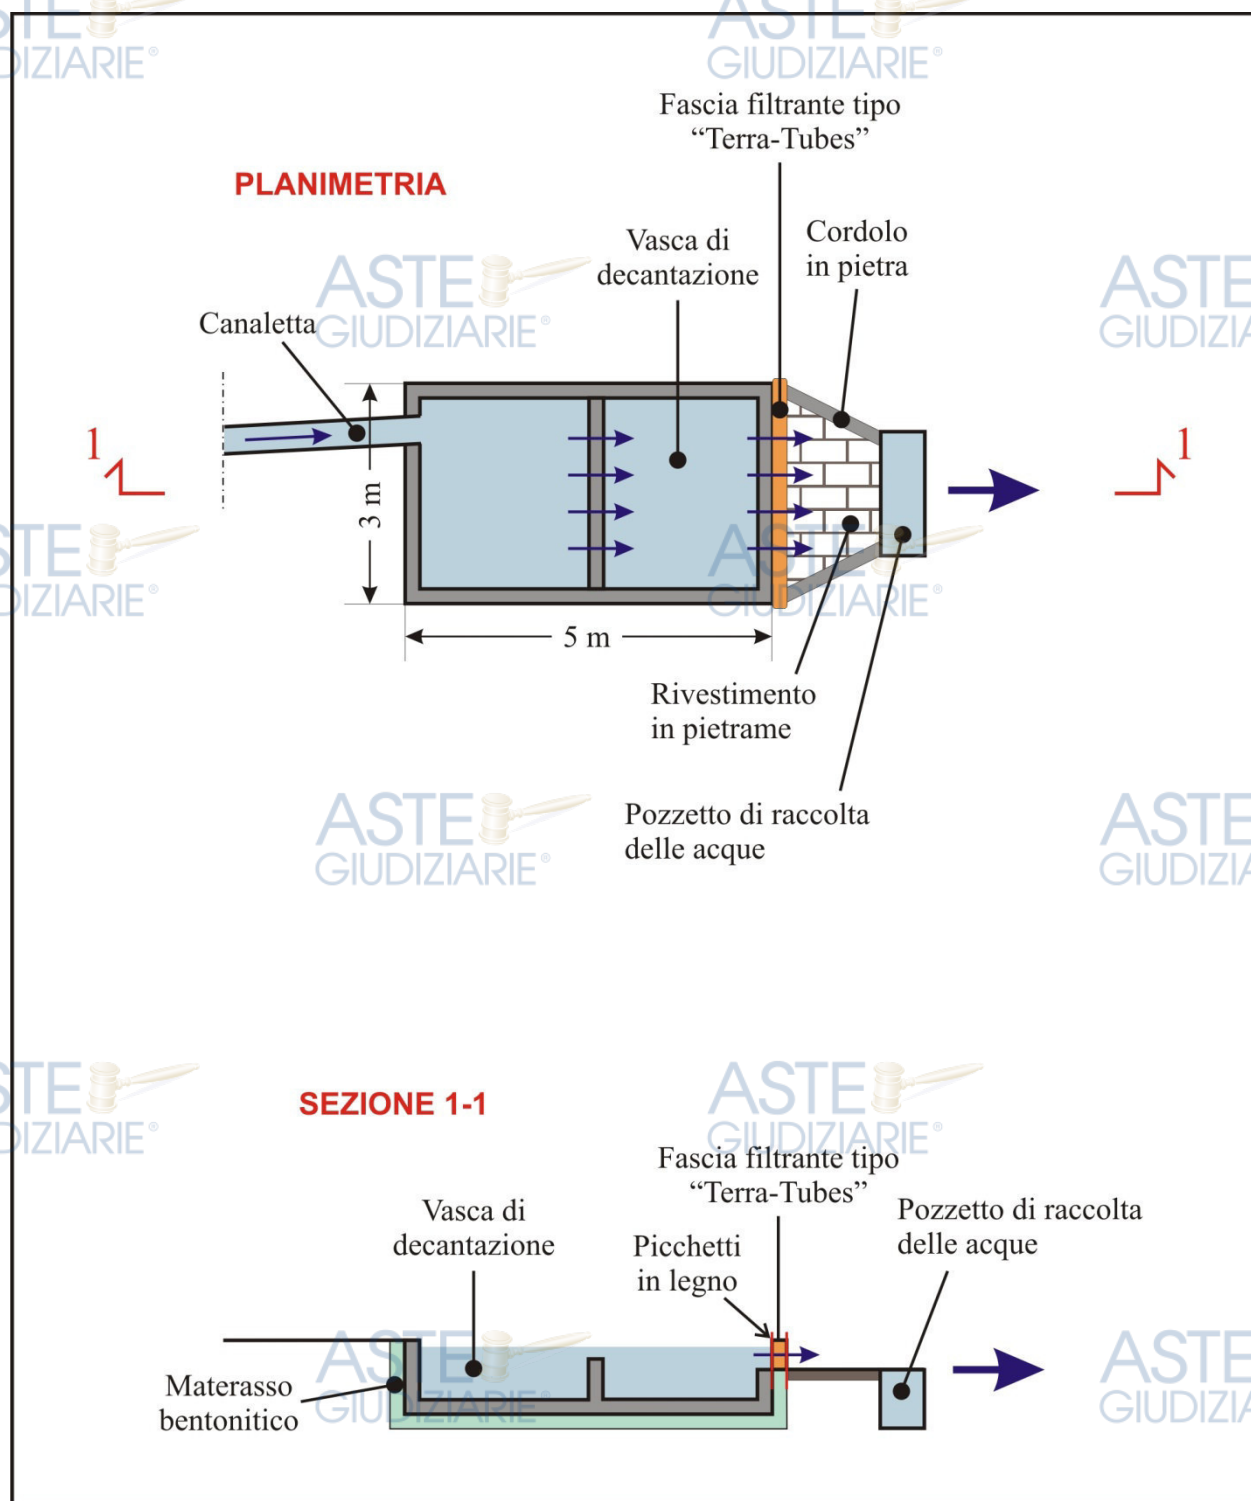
Schema con planimetria e sezione della vasca di sedimentazione e della fascia filtrante tipo "Terra-Tubes" in progetto.
